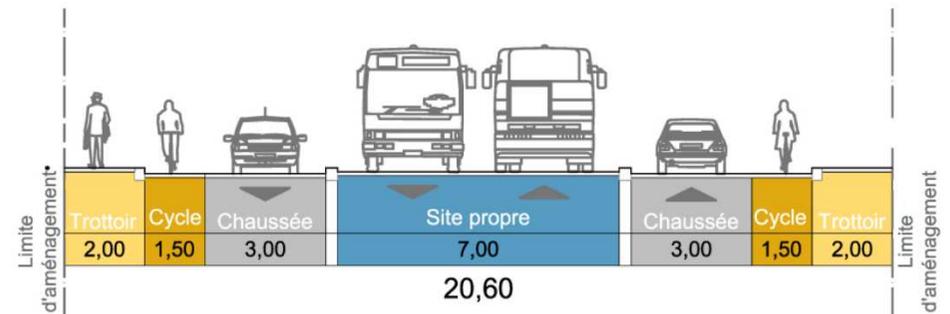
Coupe type avec cycles en section courante – emprise minimale
